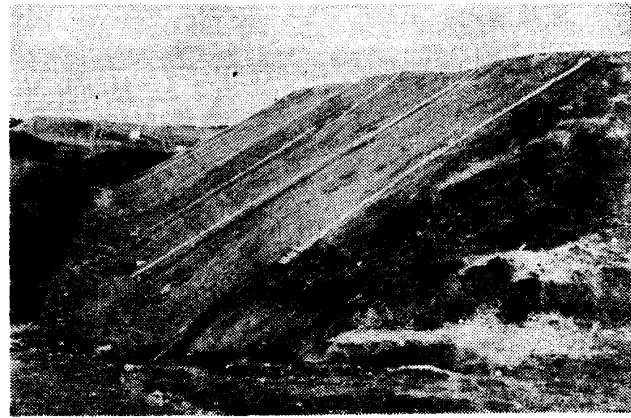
第2次現場試験施工におけるのり面安定処理（施工後6か月）
